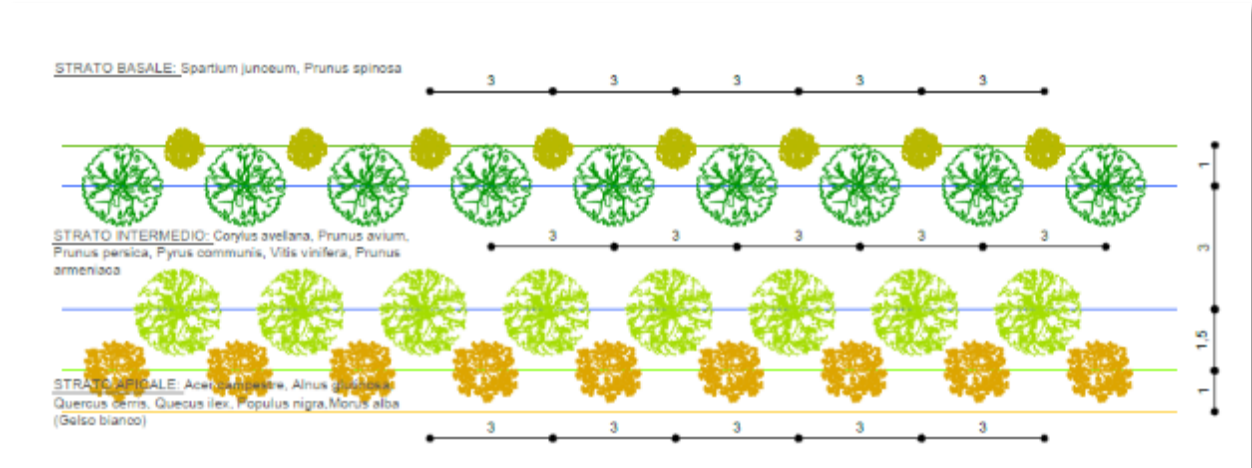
Sesto d'impianto della mitigazione esterna all'impianto
